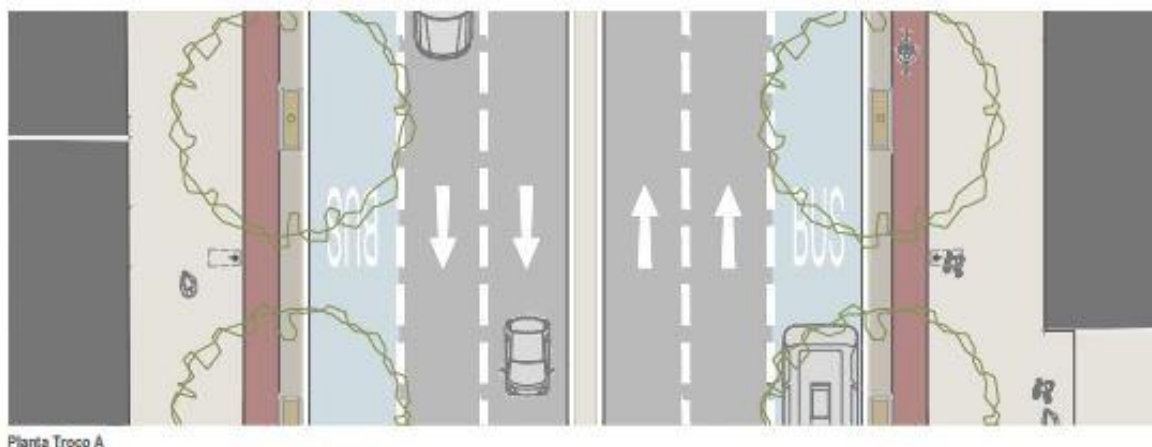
Planta do trecho A da Avenida Fontes Pereira de Melo
